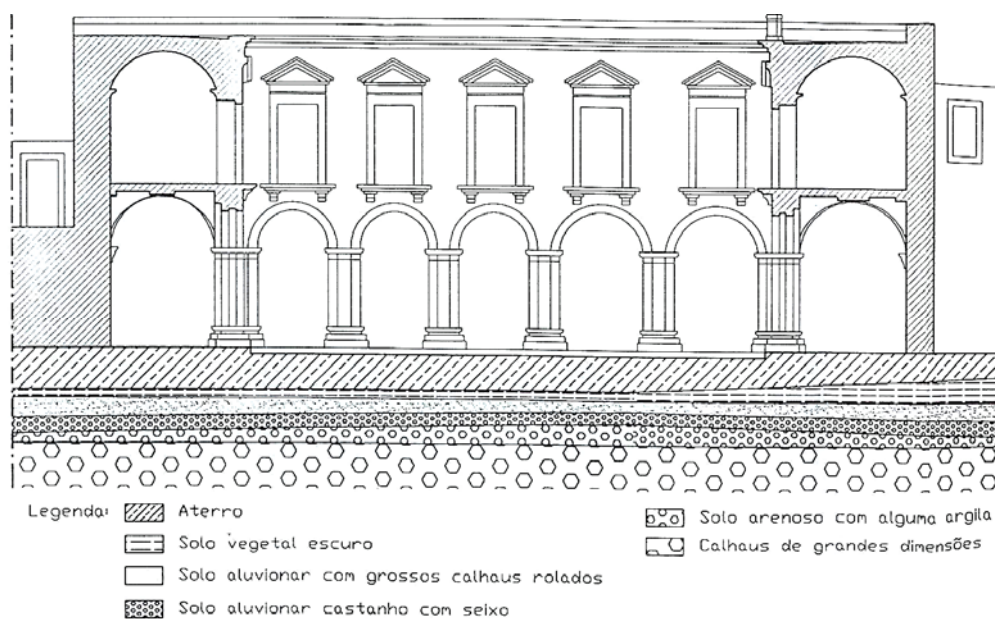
[4j]: Perfil geotécnico. Corte Nascente – Poente
